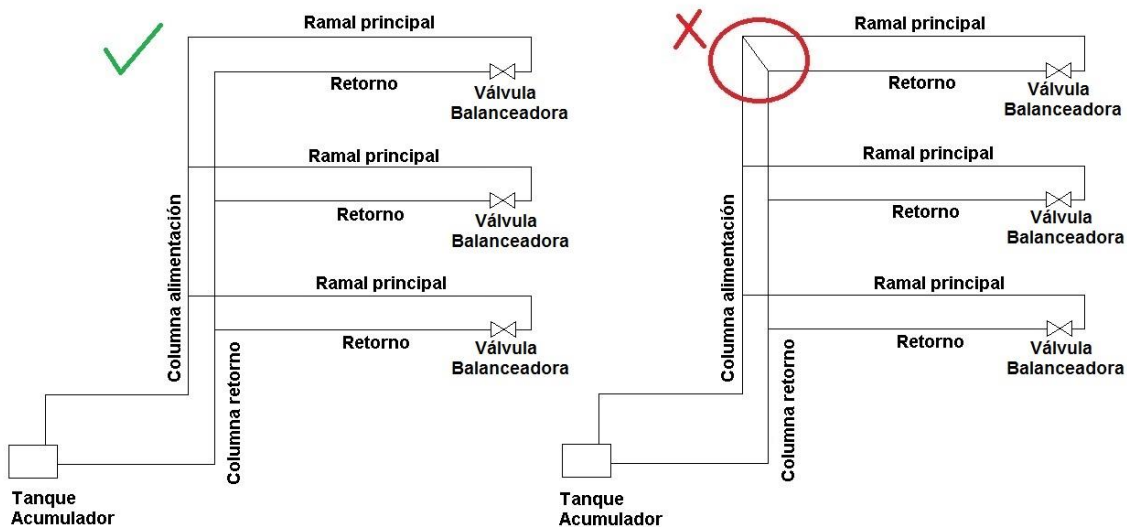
Conexión correcta y errada de columna de alimentación y retorno
